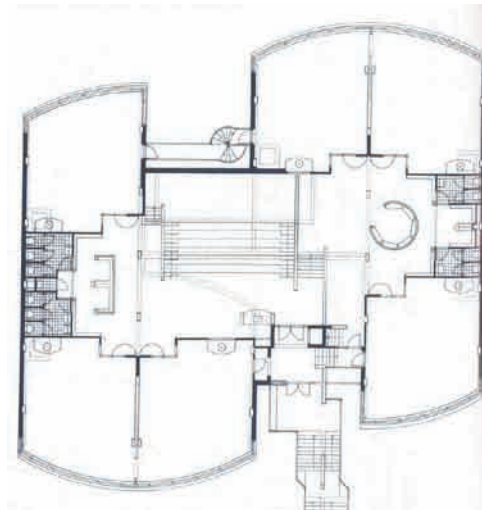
Plan wat vloeiende ruimtes en skakeling tussen klaskamers toon
